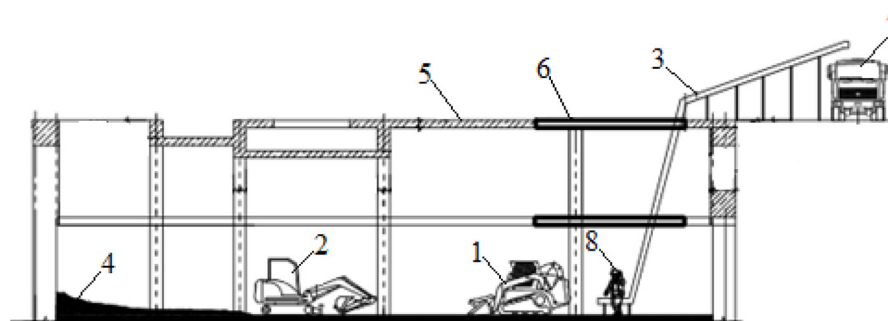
Схема выемки грунта при помощи конвейера: 1 – погрузчик; 2 – мини экскаватор; 3 – конвейер; 4 – грунт; 5 – монолитное перекрытие; 6 – технический проём; 7 – самосвал; 8 – рабочий
